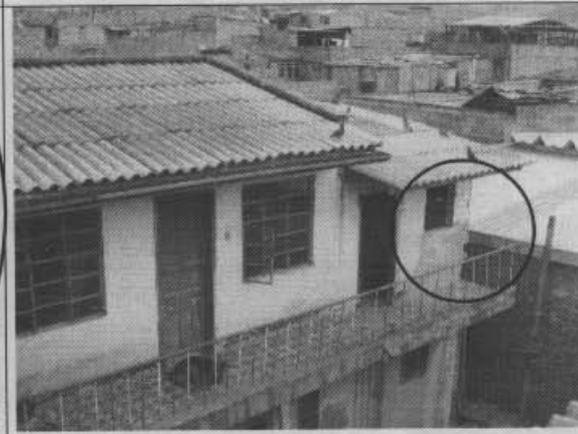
Desprendimiento parciales de muros en algunos sectores de la construcción.
